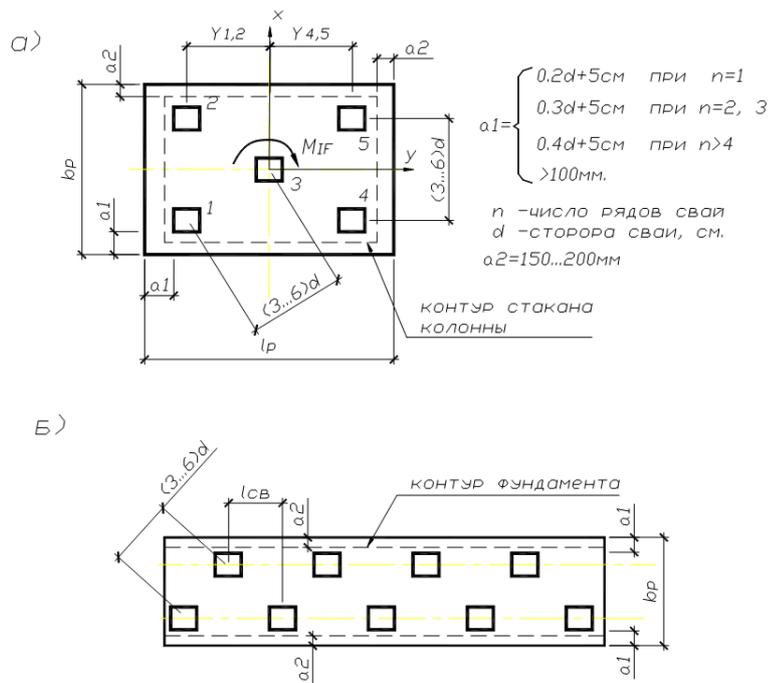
Конструктивные требования при проектировании ростверков: а) – столбчатого фундамента; б) - ленточного фундамента.
